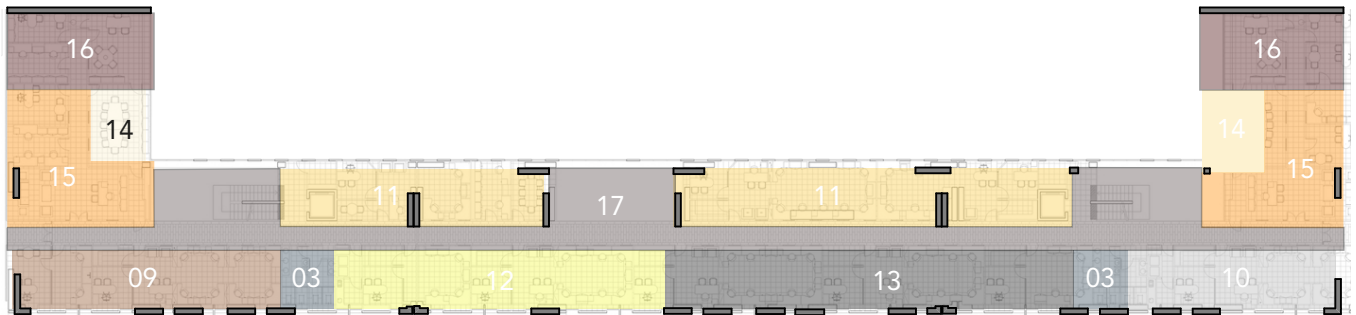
Distribución de áreas planta tipo de SERVIU (2015). Elaborado por el autor
